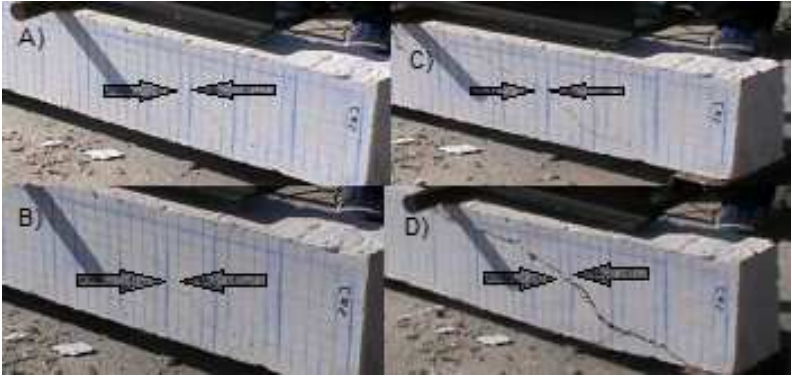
Patrón de grietas de la viga CR2.
